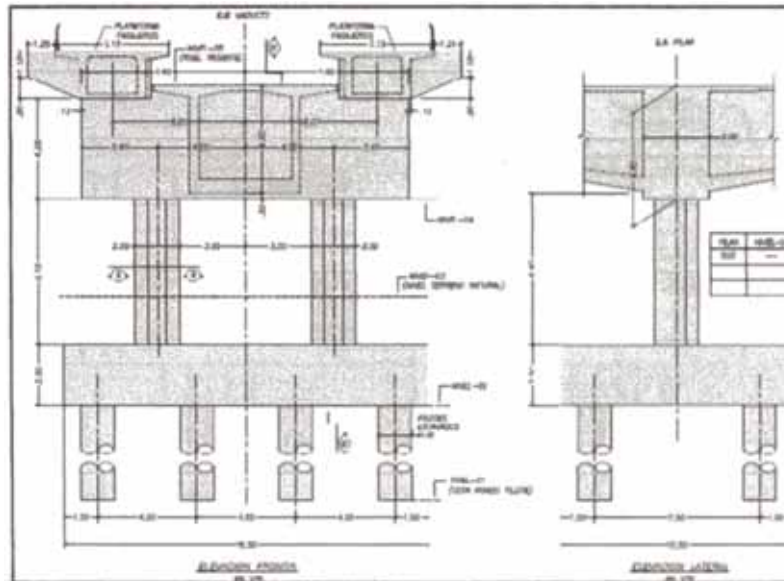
Elevación Pilar S50 (el S51 es similar)
